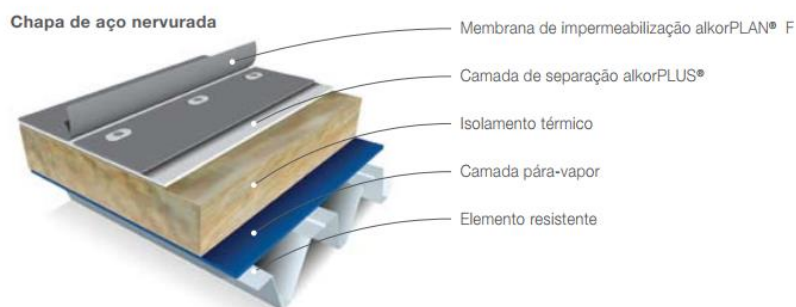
Exemplo de aplicação do sistema de impermeabilização da cobertura com estrutura metálica
